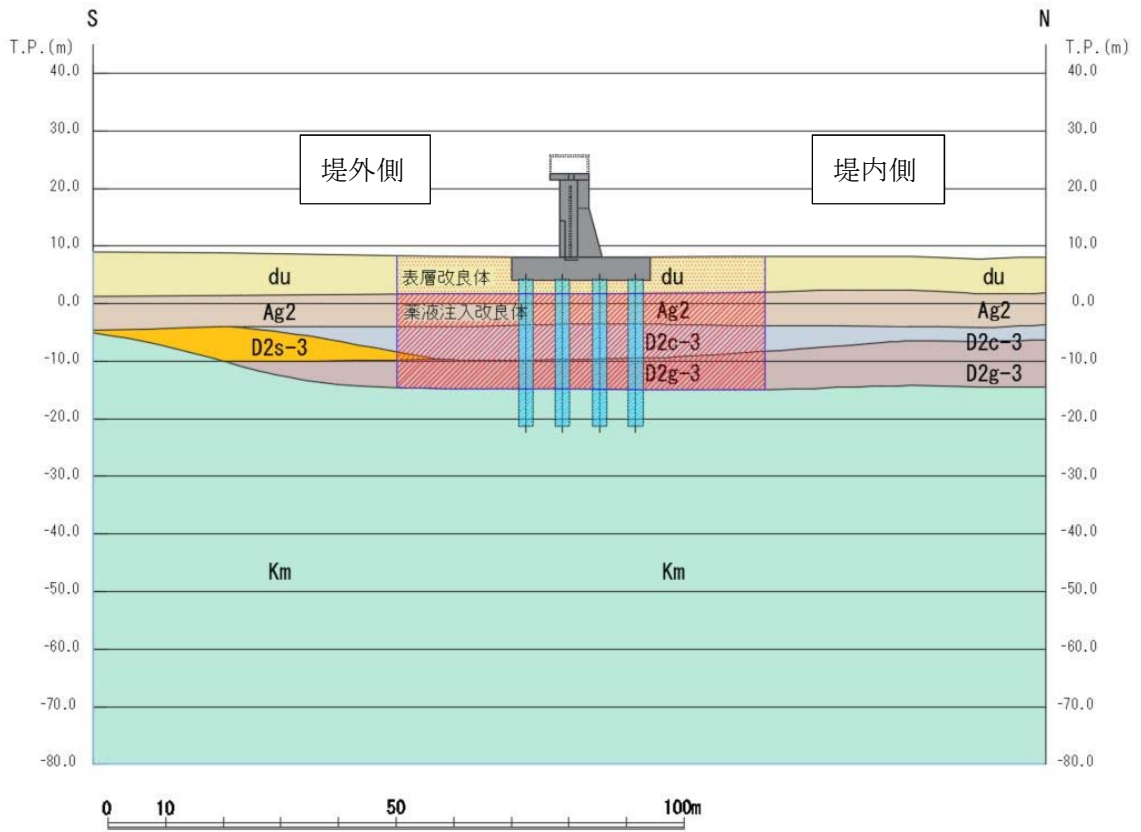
(1) 評価対象断面図 (A-A断面)
